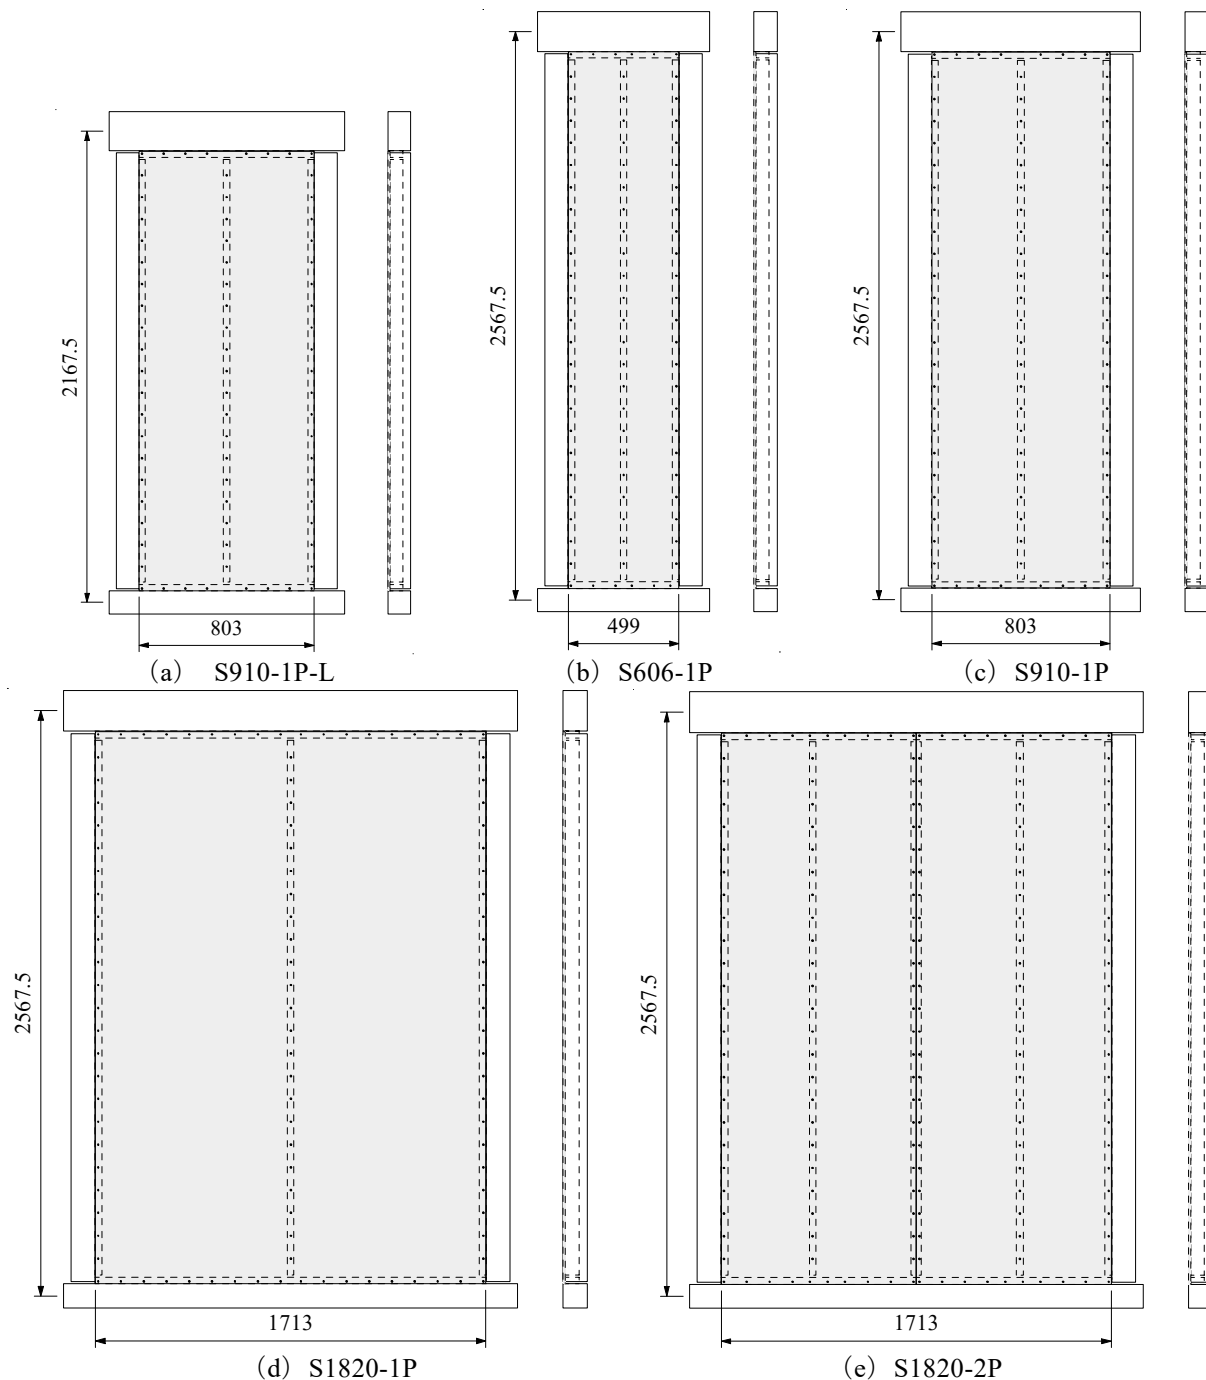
解析モデルの形状・寸法 (寸法単位：mm)
